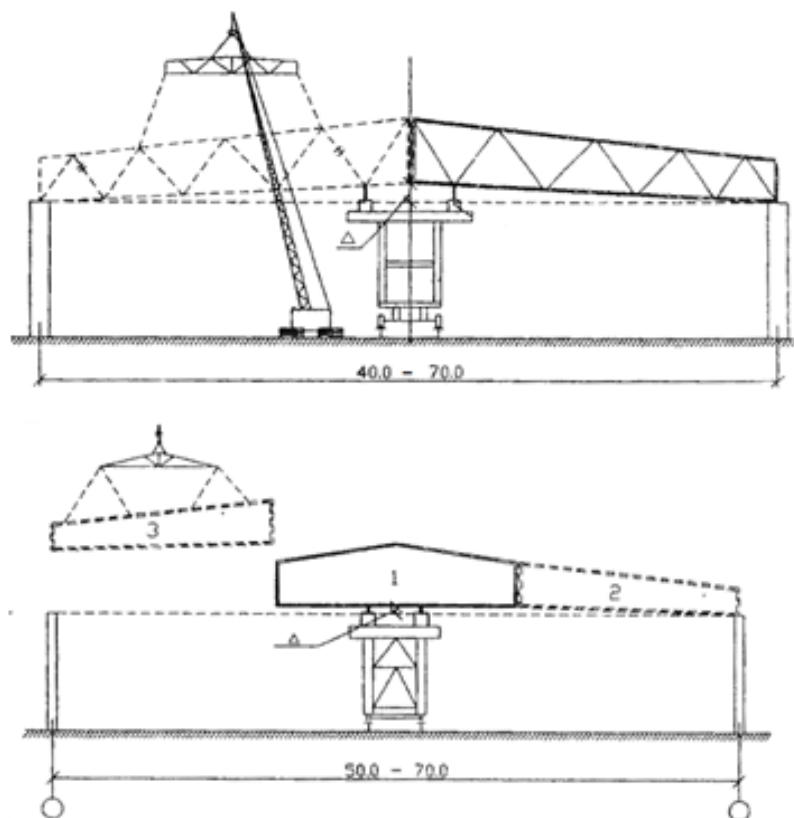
Схемы монтажа балочных конструкций на временных промежуточных опорах:
